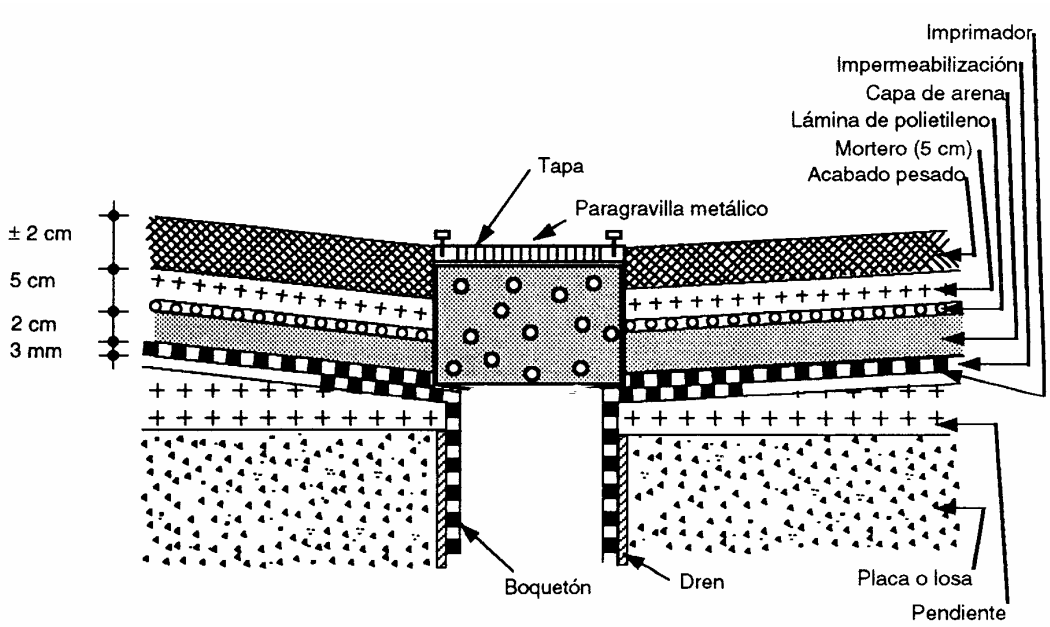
Impermeabilización de bajantes o drenes
